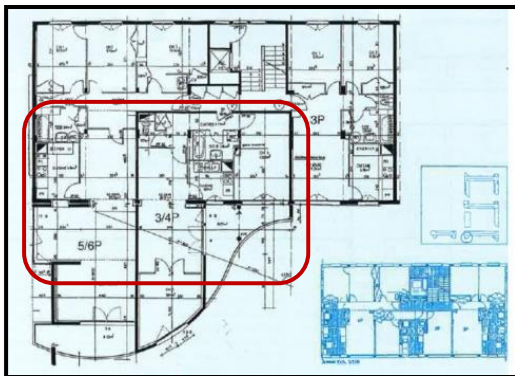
Plan type de logement avec extension du pignon. Source : [www.amc-archi.com](http://www.amc-archi.com) 2015
